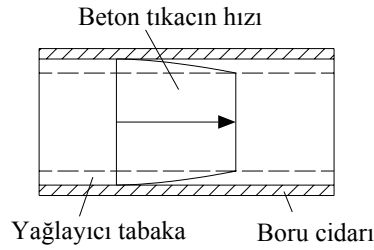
Silindirik tıkaç şeklinde betonun akışı
